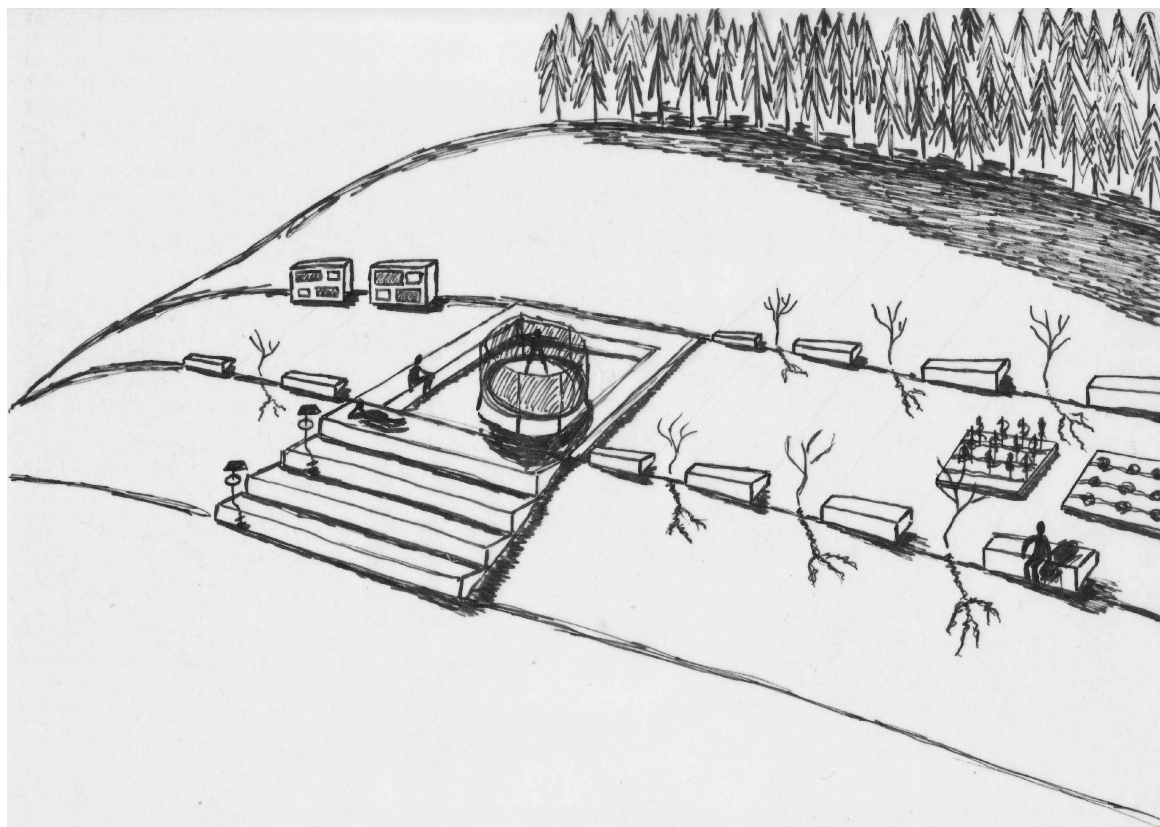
Návrh 3, skica altánu – bez zastřešení
